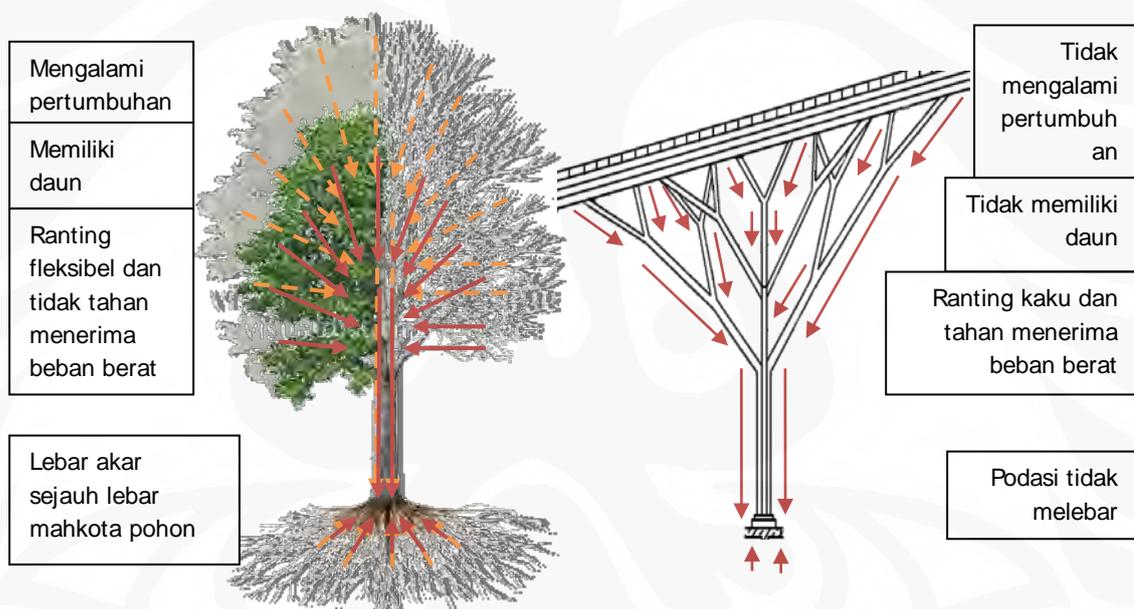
Struktur pohon baja membentuk suatu susunan segitiga
